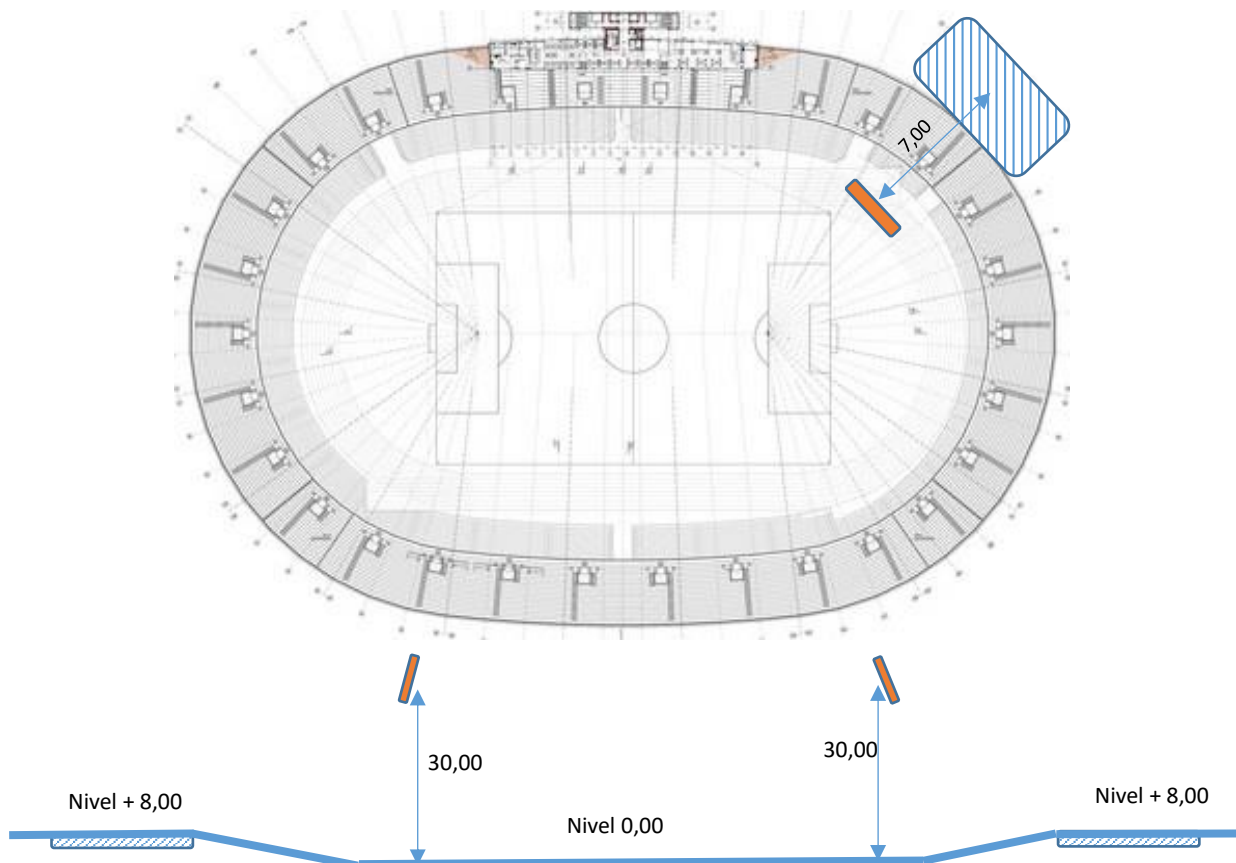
Planta y corte esquemático del estadio y la posición de las luminarias
